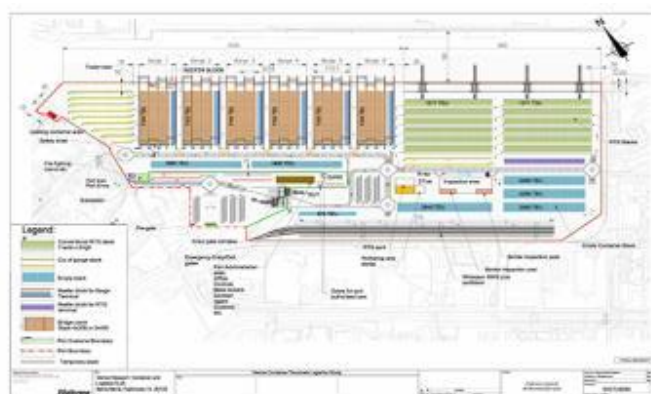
Planimetria progetto favorevolmente esaminato in VIA Nazionale
